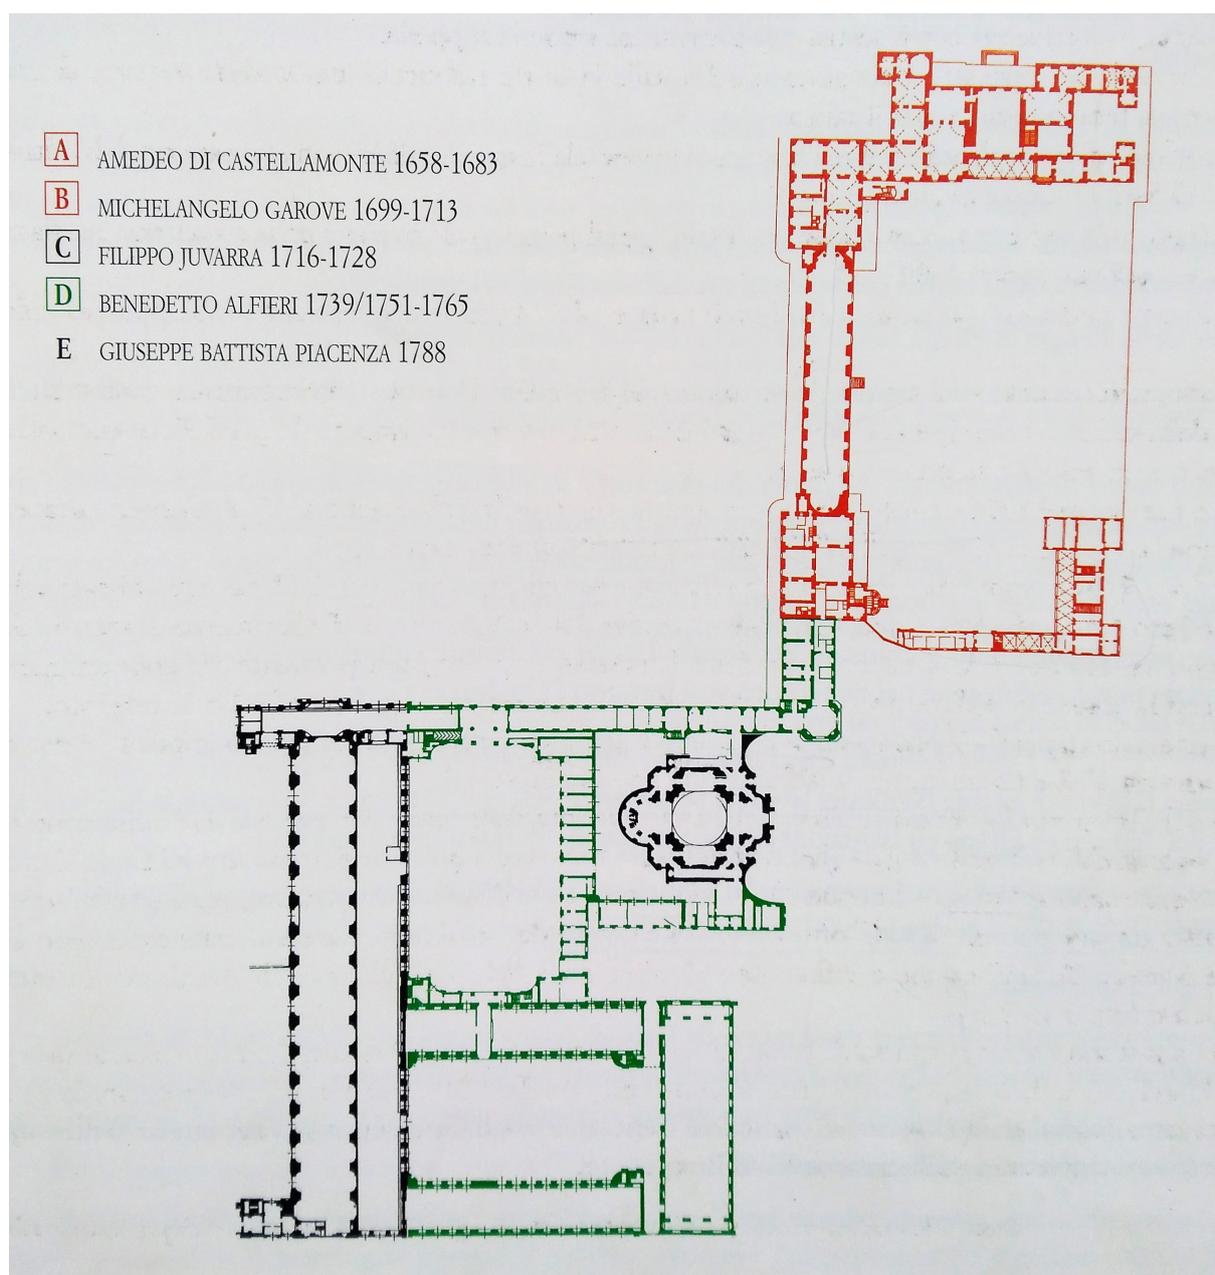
Pianta della Reggia di Venaria con le cinque fasi di costruzione.
